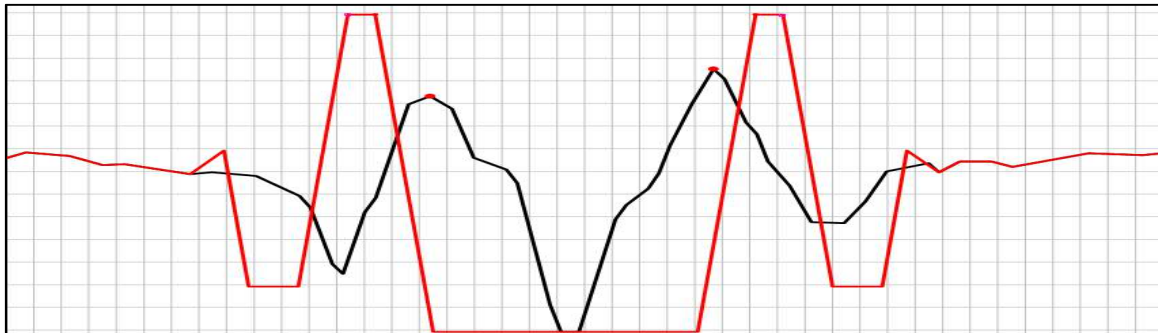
Schematizzazione della nuova sezione idraulica – In nero lo stato attuale e in rosso la nuova sezione
